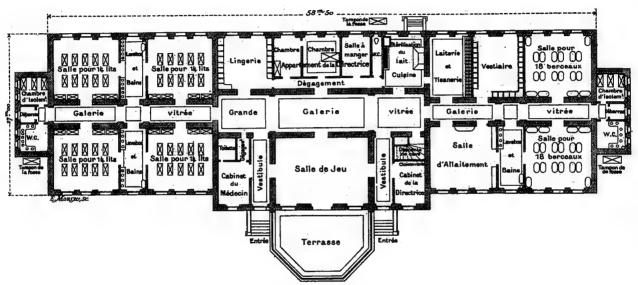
Crèche municipale de la ville d'Héricourt (voir page 310), plan du rez-de-chaussée.
